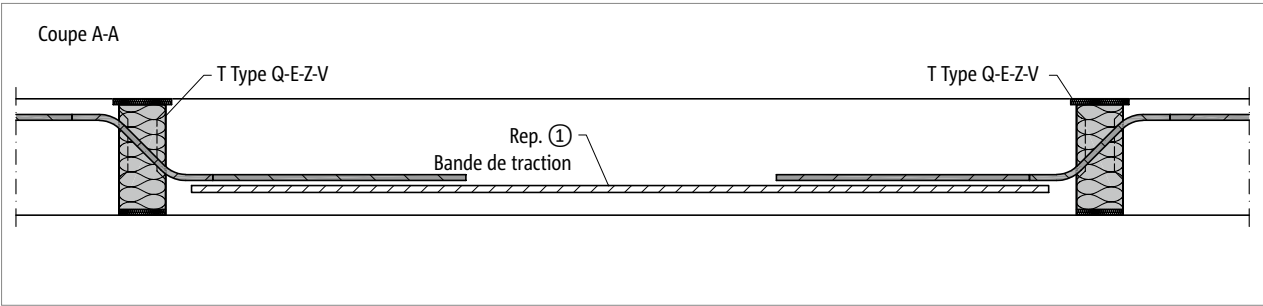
Schöck Isokorb® T Type Q-E-Z-V : Raccordement de renforcement - Bande de traction
